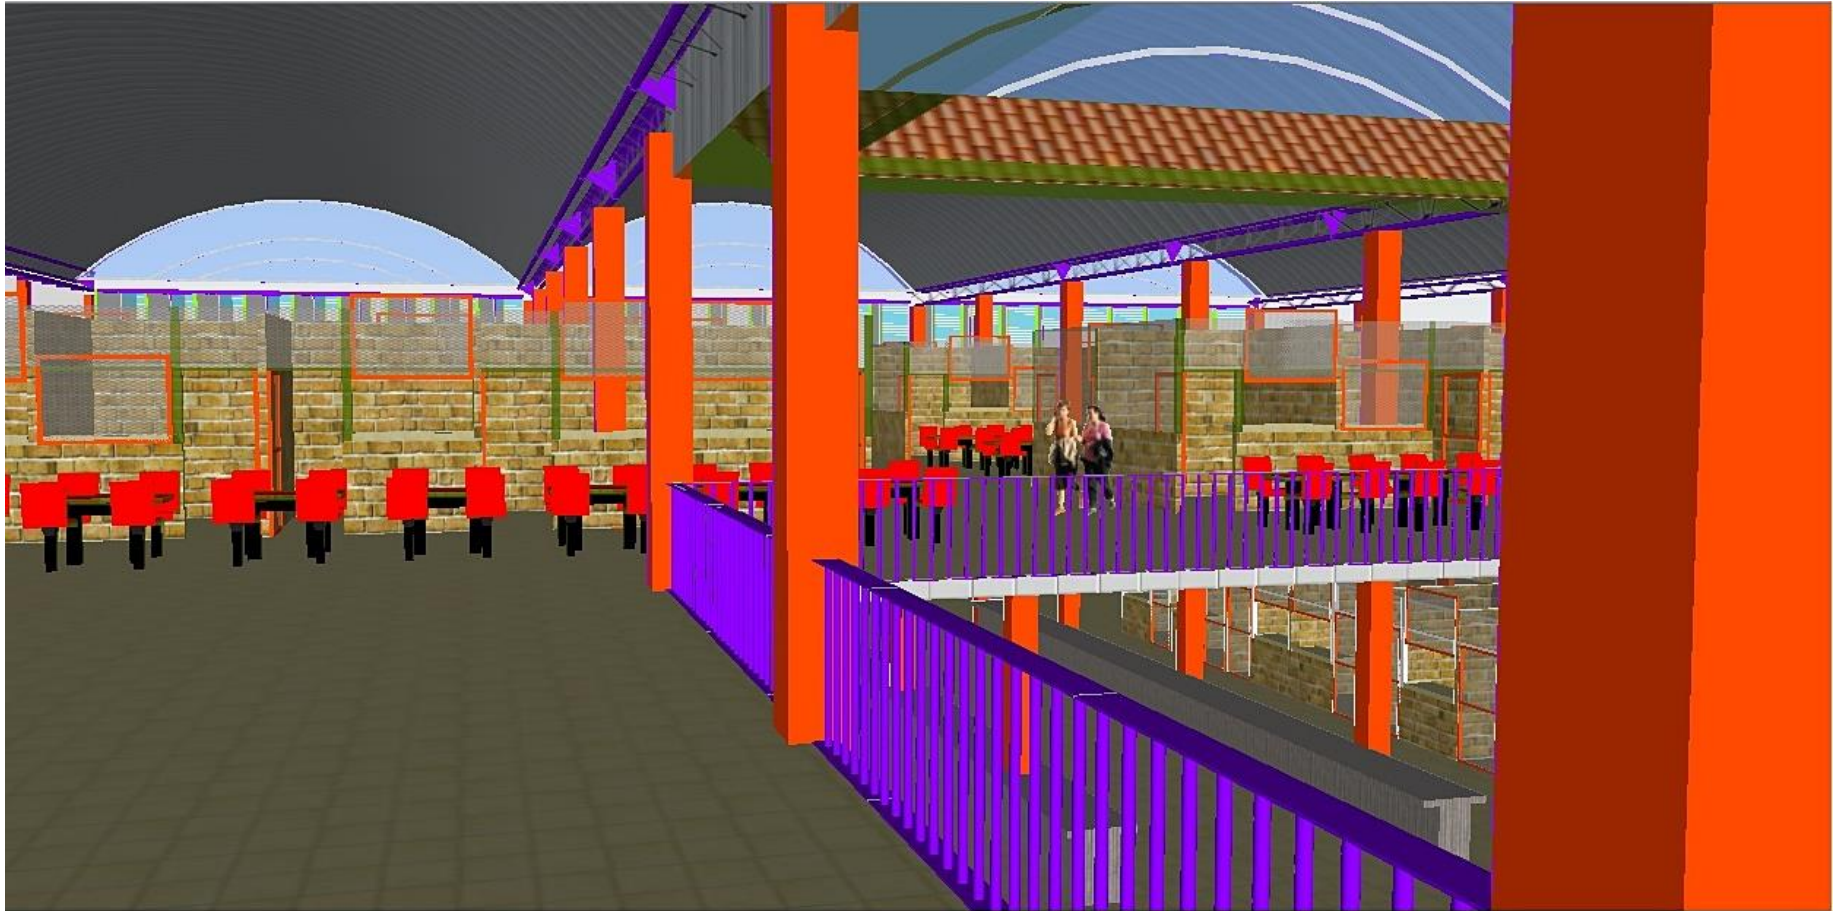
Vista interior de segundo nivel, a la derecha barandal, al fondo puestos de Pupusería y mesas
